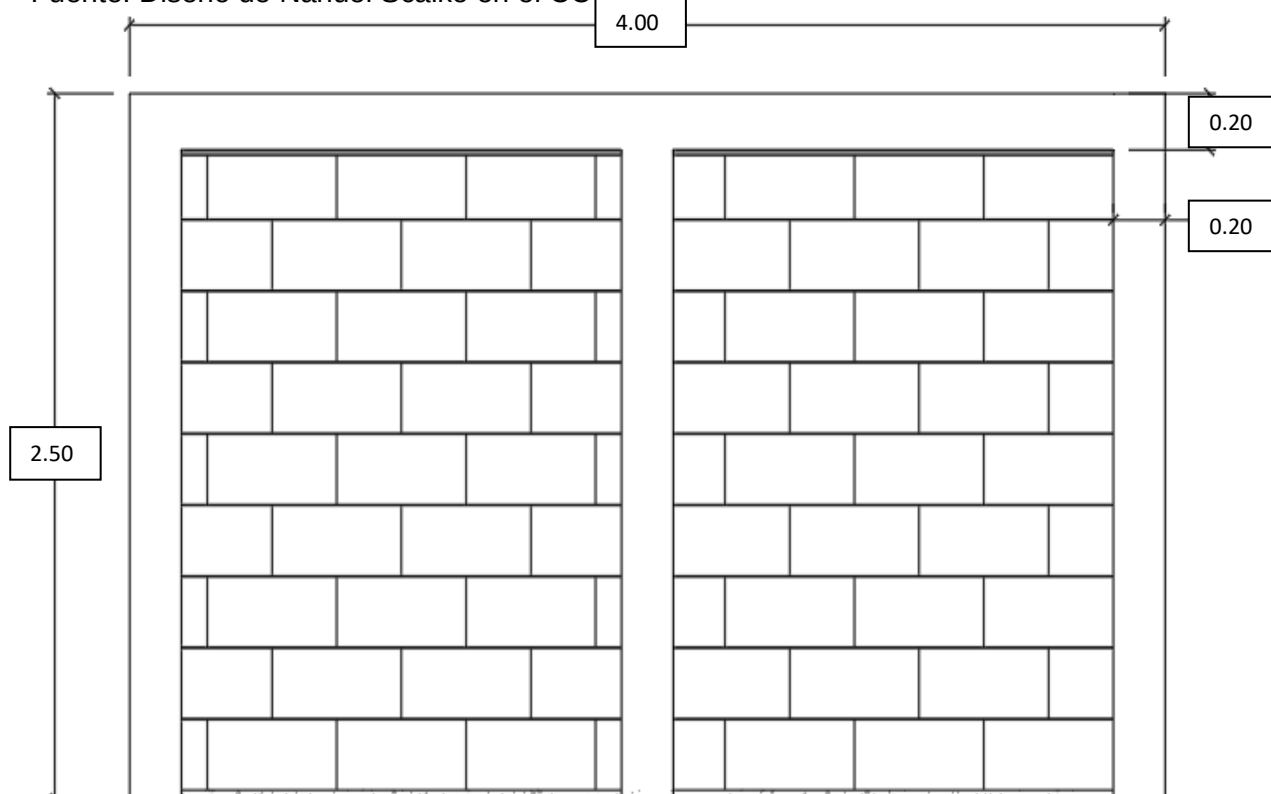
Vista del muro Tipo D, de construcción mixta.
